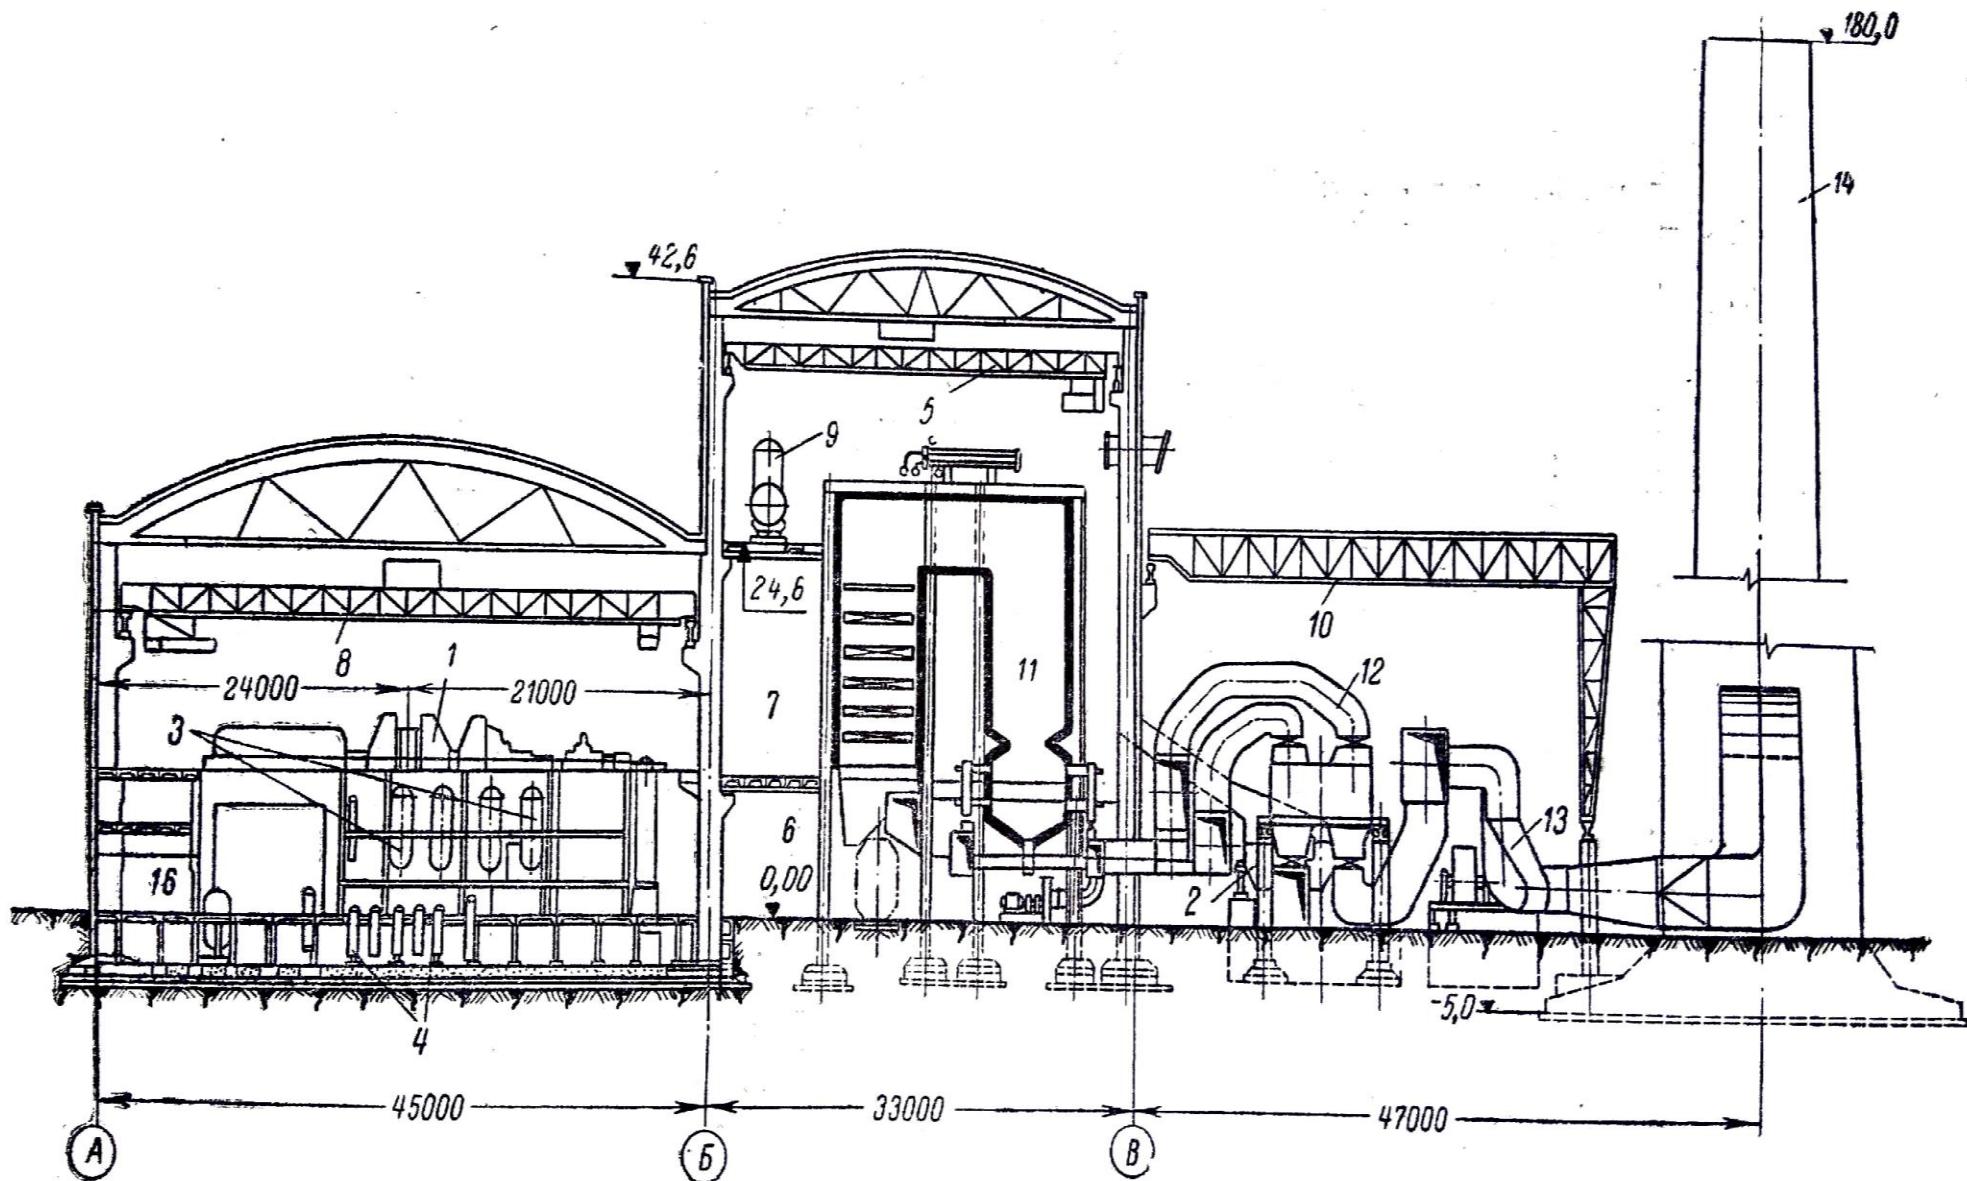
Компоновка главного корпуса с разворотом топки газомазутного котла к наружной стене (поперечный разрез).
